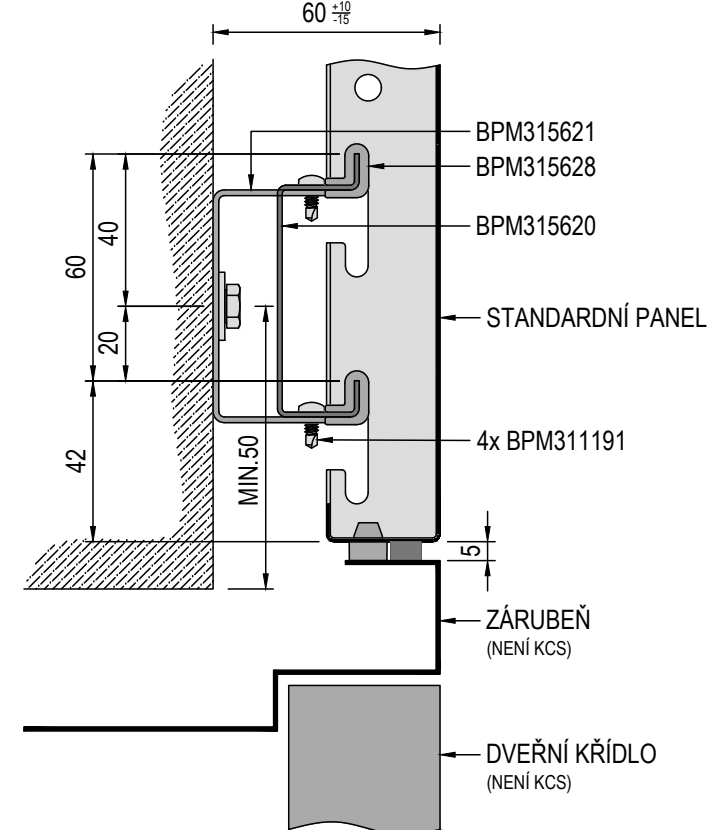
SPECIÁLNÍ VIDITELNÝ KONEC
